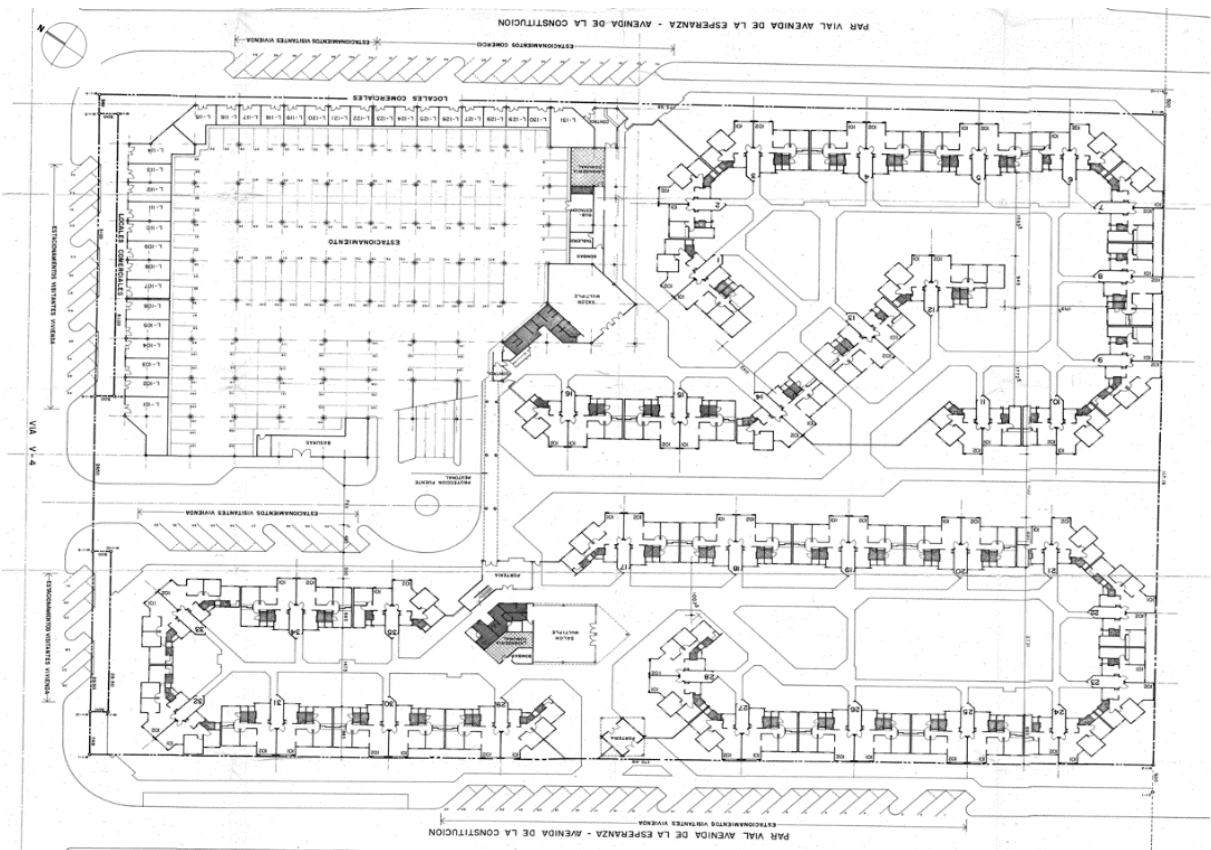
Plano Implantación Conjunto Residencial Alcaparros de Sauzalito. Fuente: (Archivo Distrital de planiación).
